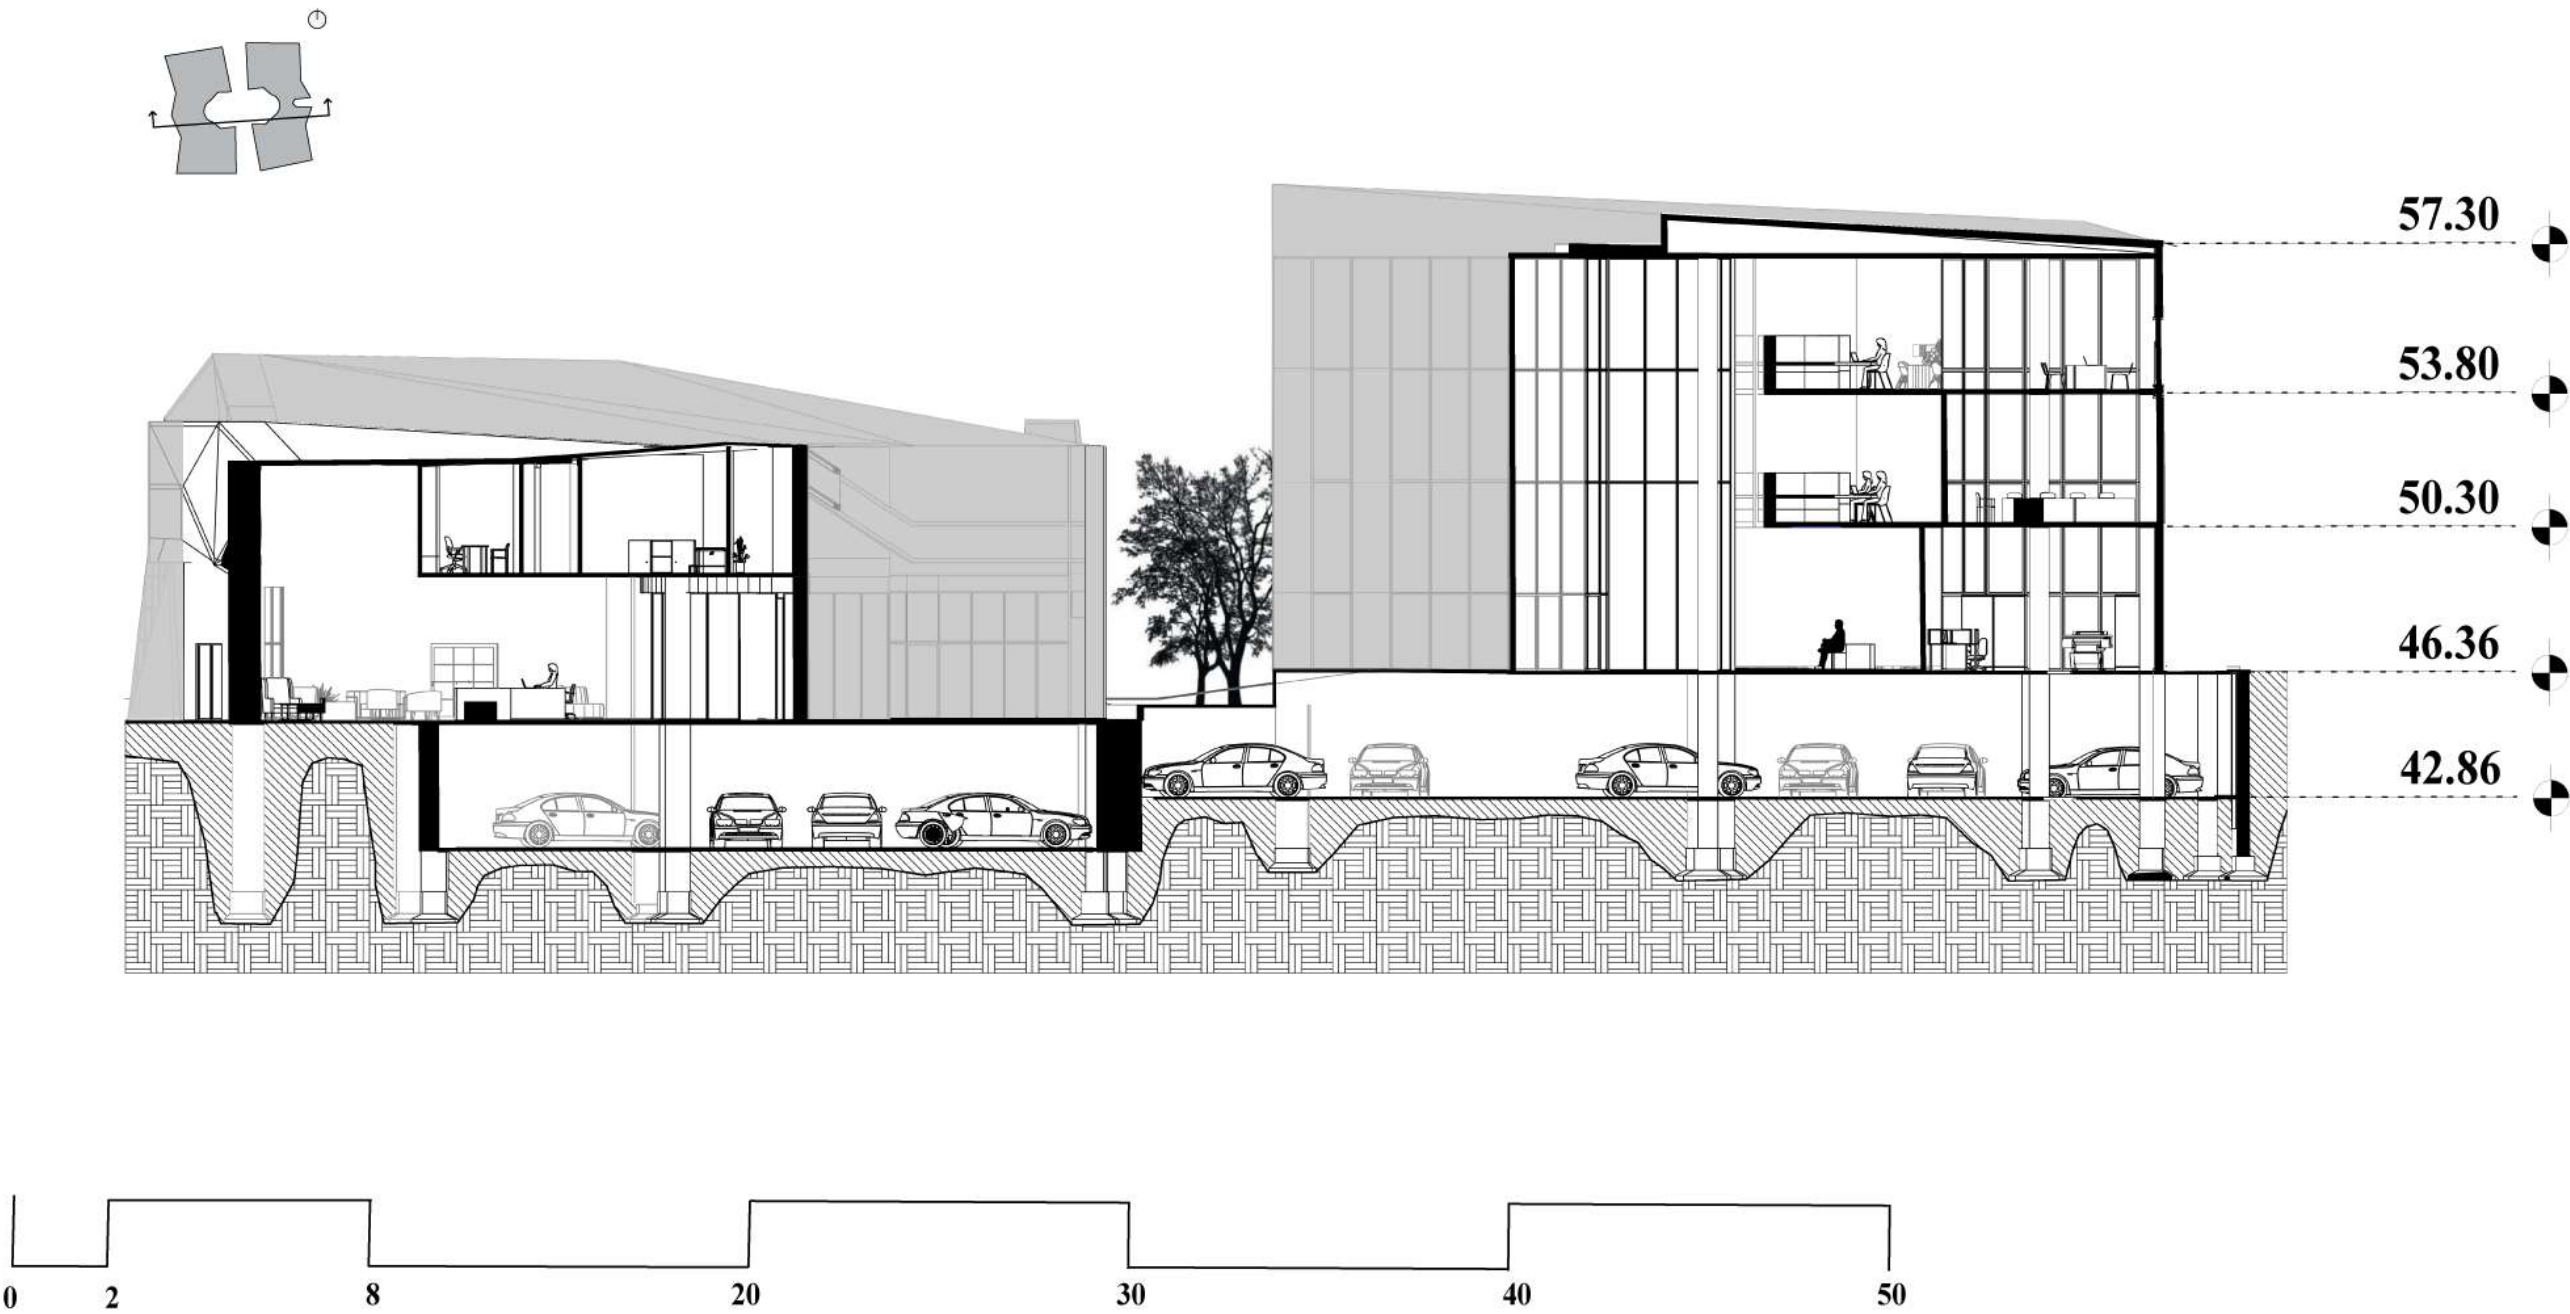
Sección B-B, edificio B, elaborado por autor, 2024.
